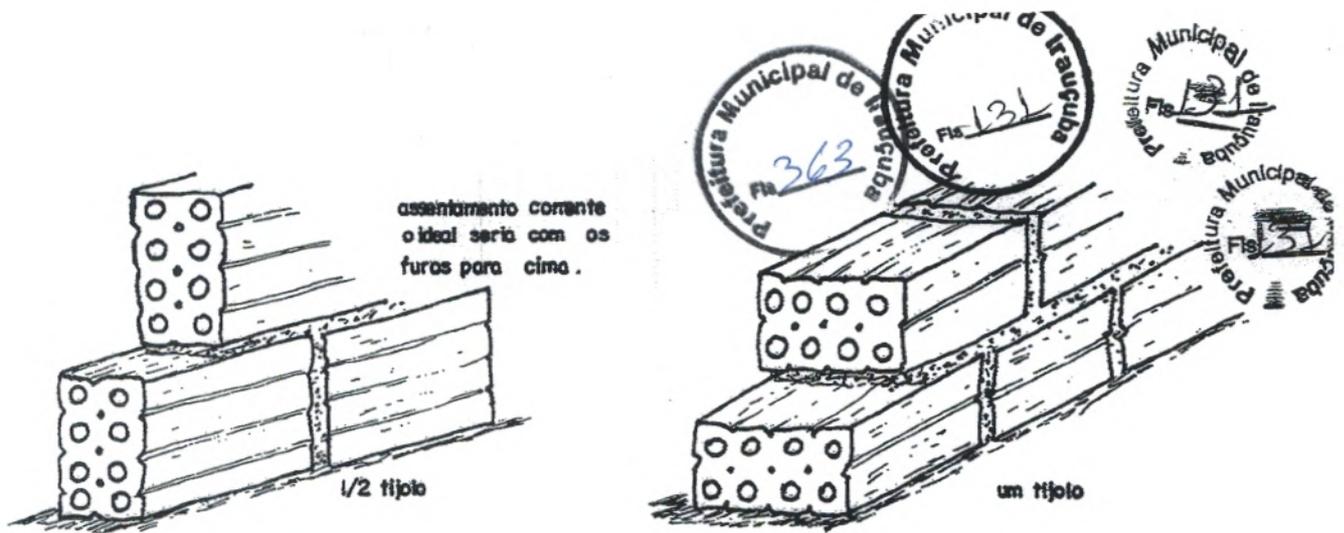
Execução de alvenaria utilizando tijolos furados.
